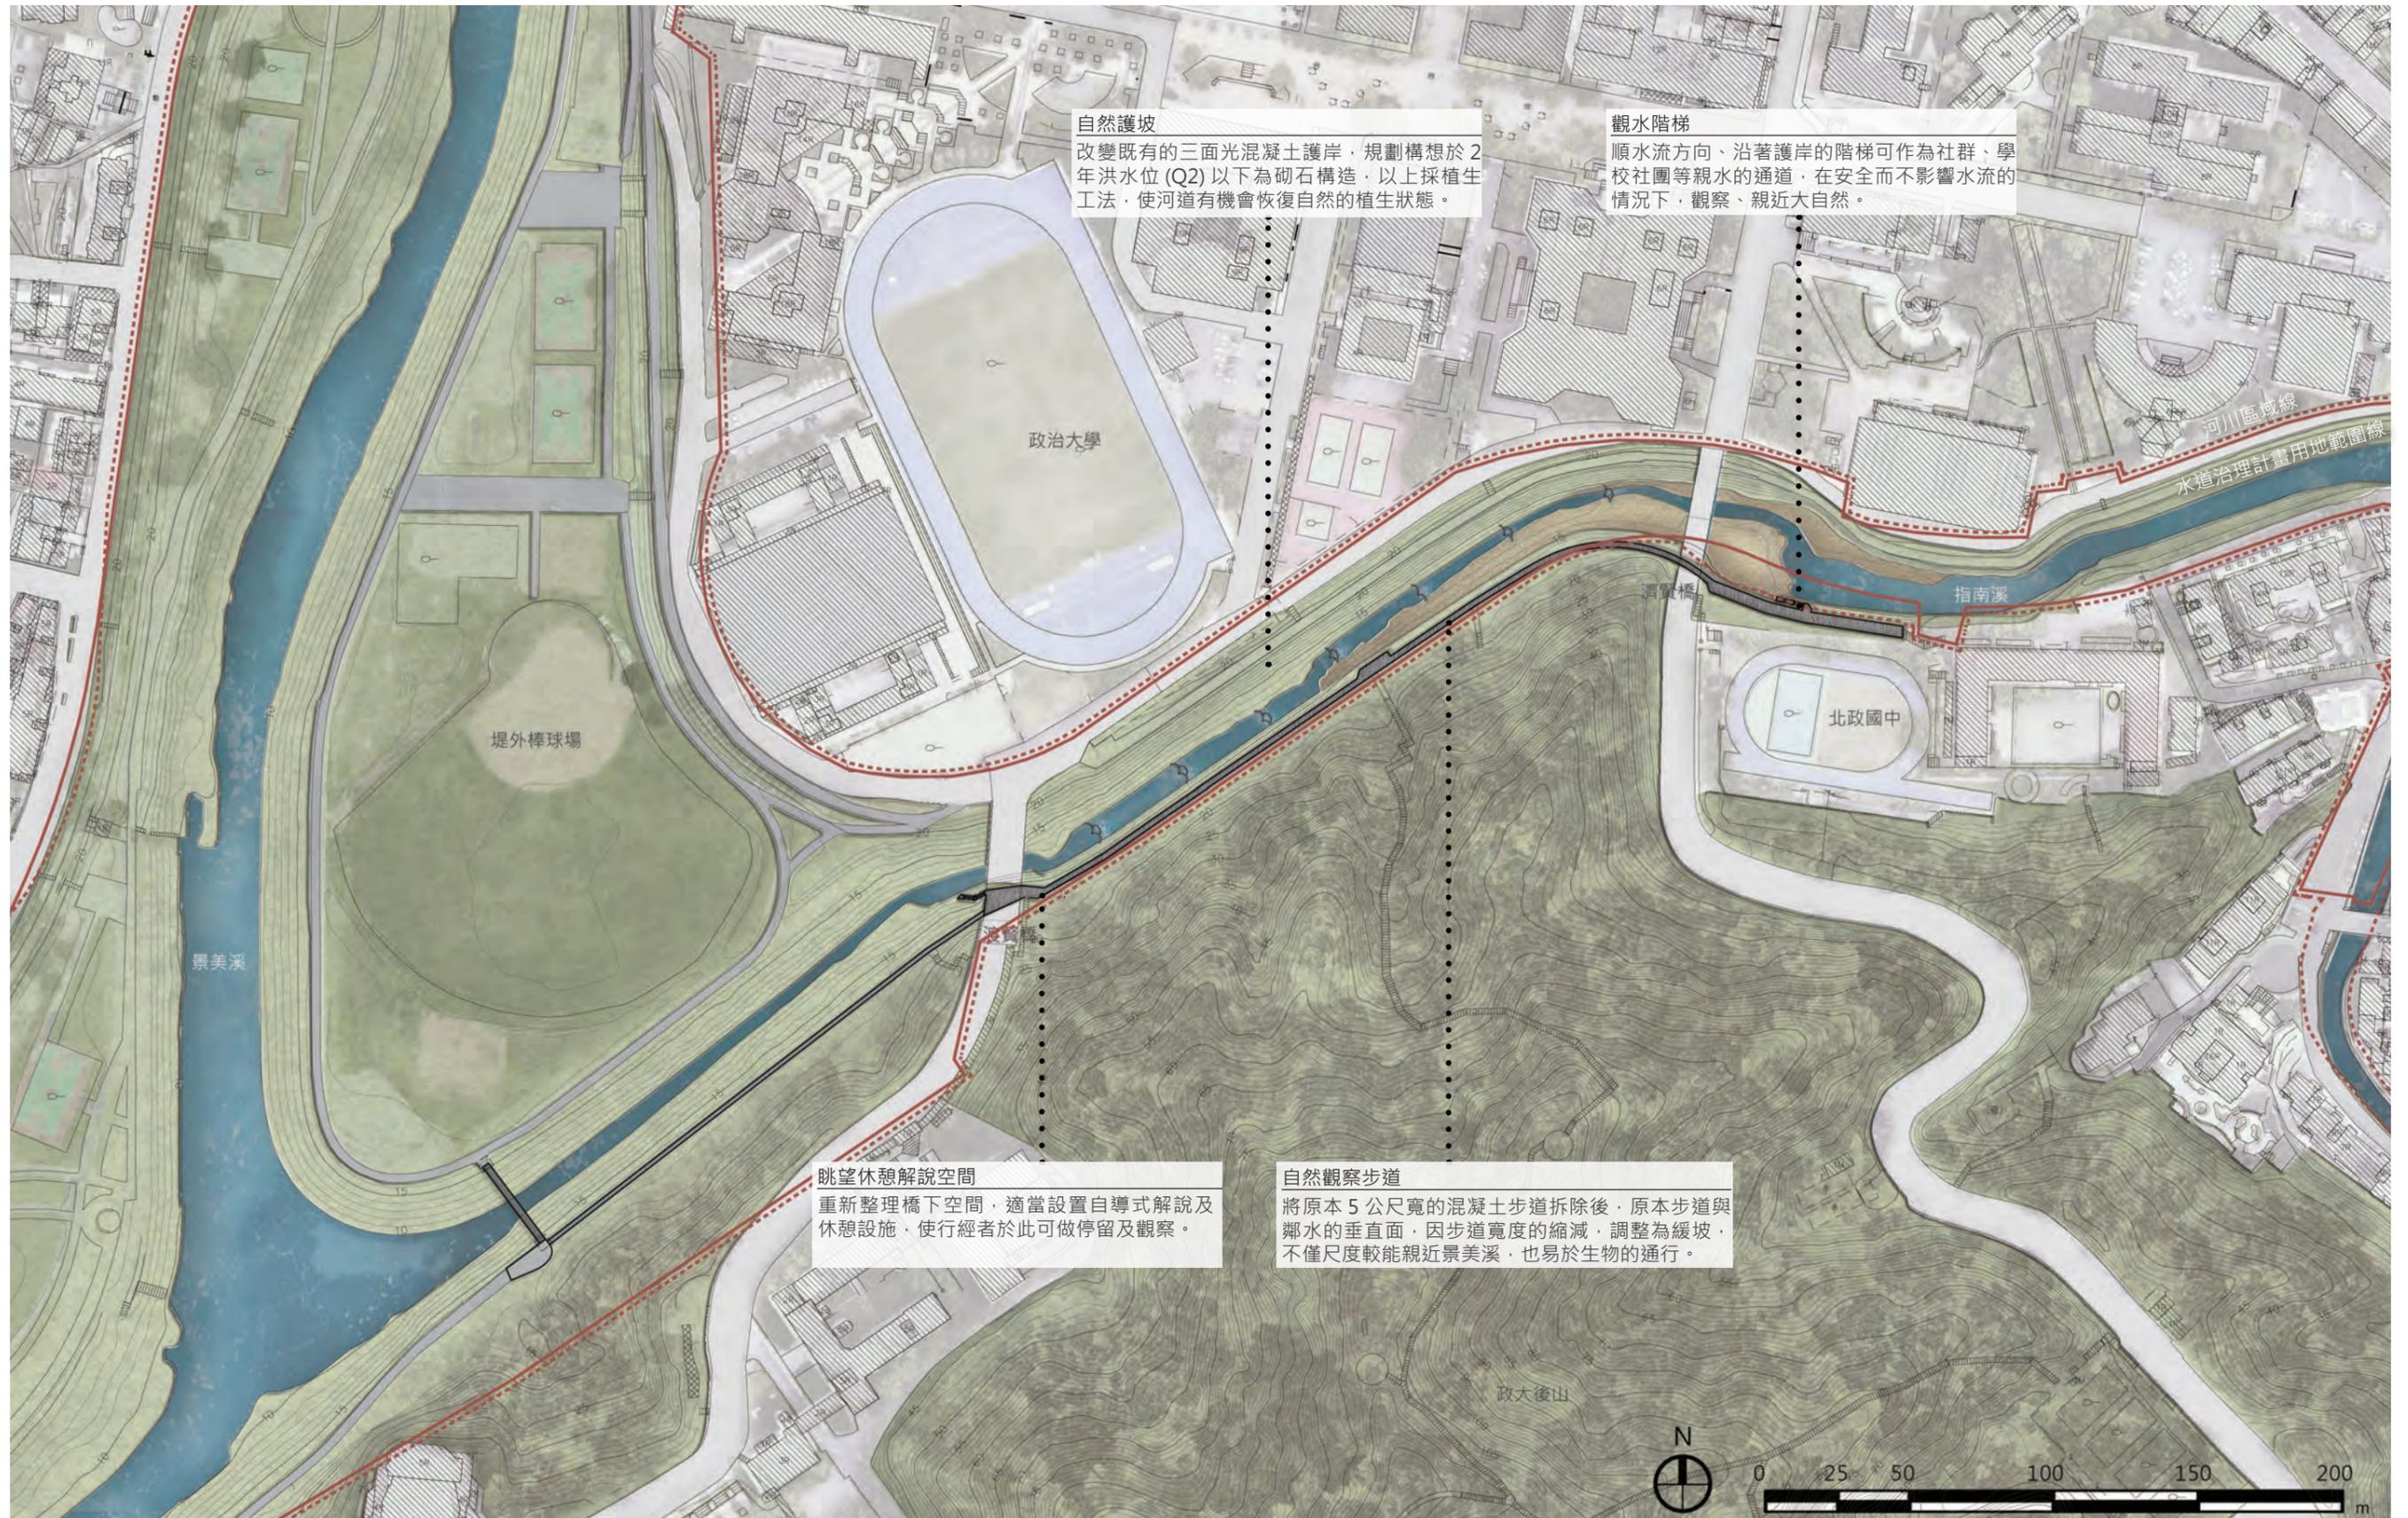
人文生態護育段 - 平面配置設計圖
